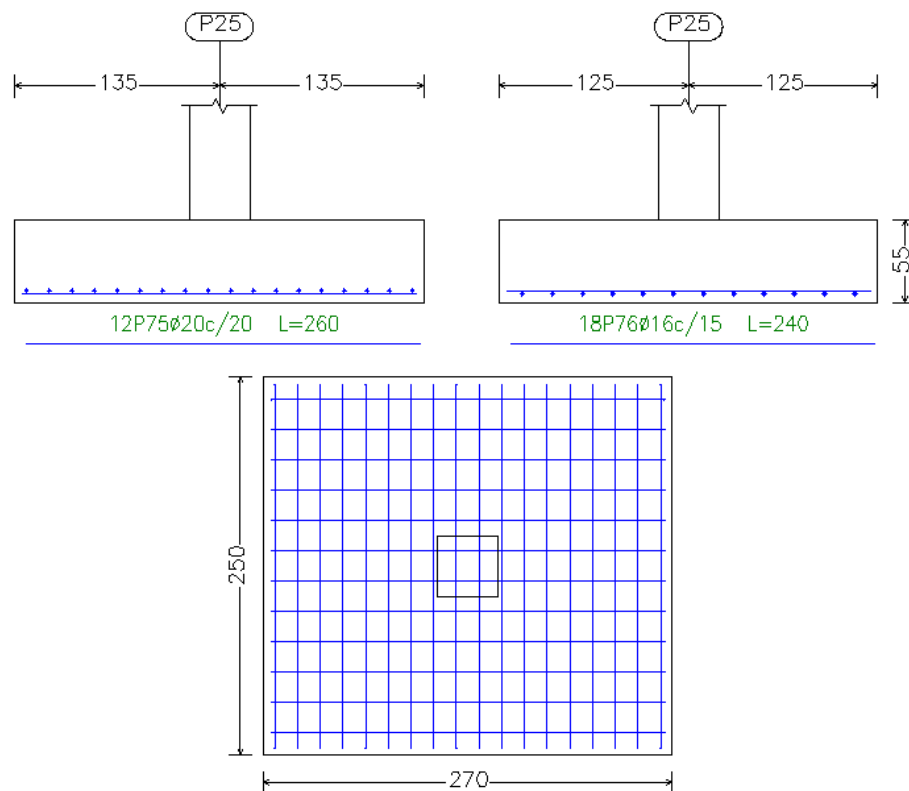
Despiece Zapata Central; Elaboración Propia
